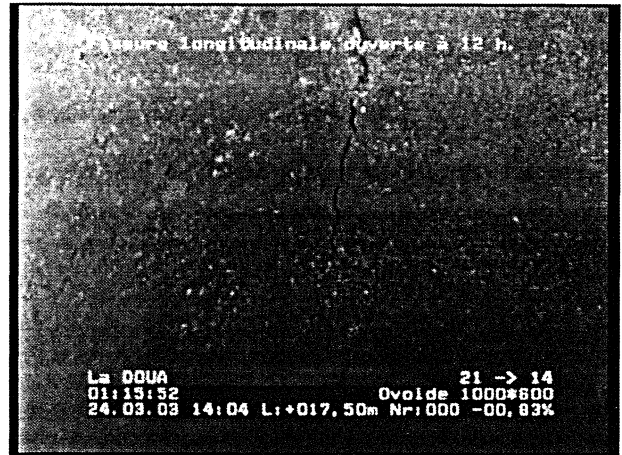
\_3a, N° cassette: 1, 01:15:51
